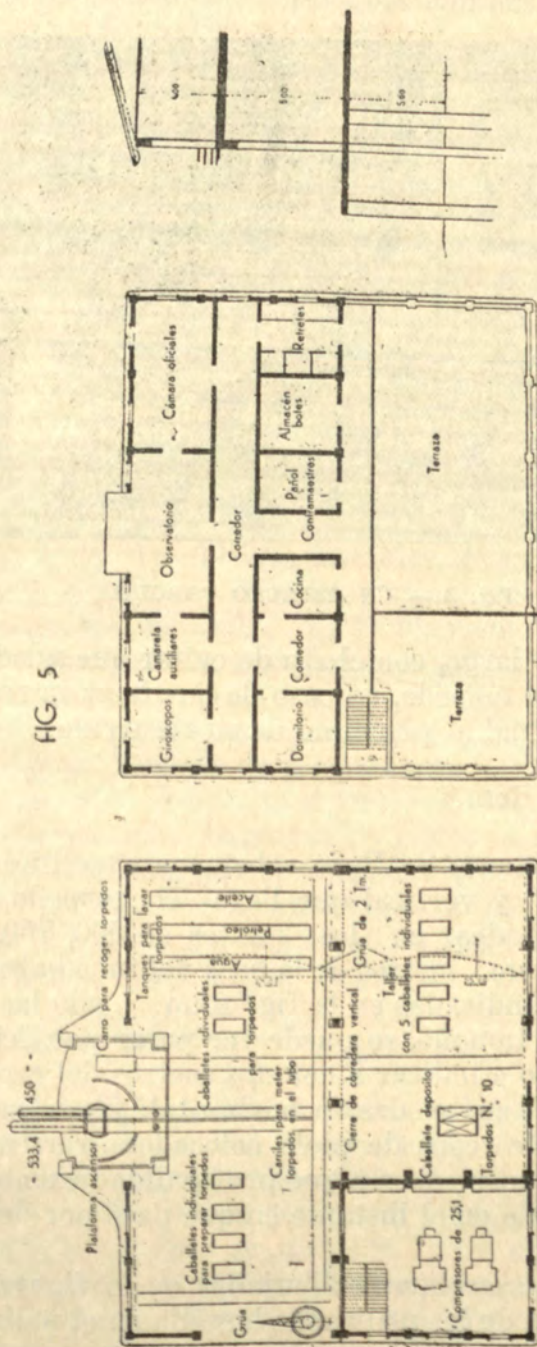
ANTEPROYECTO DE PUENTE DE LANZAMIENTO
